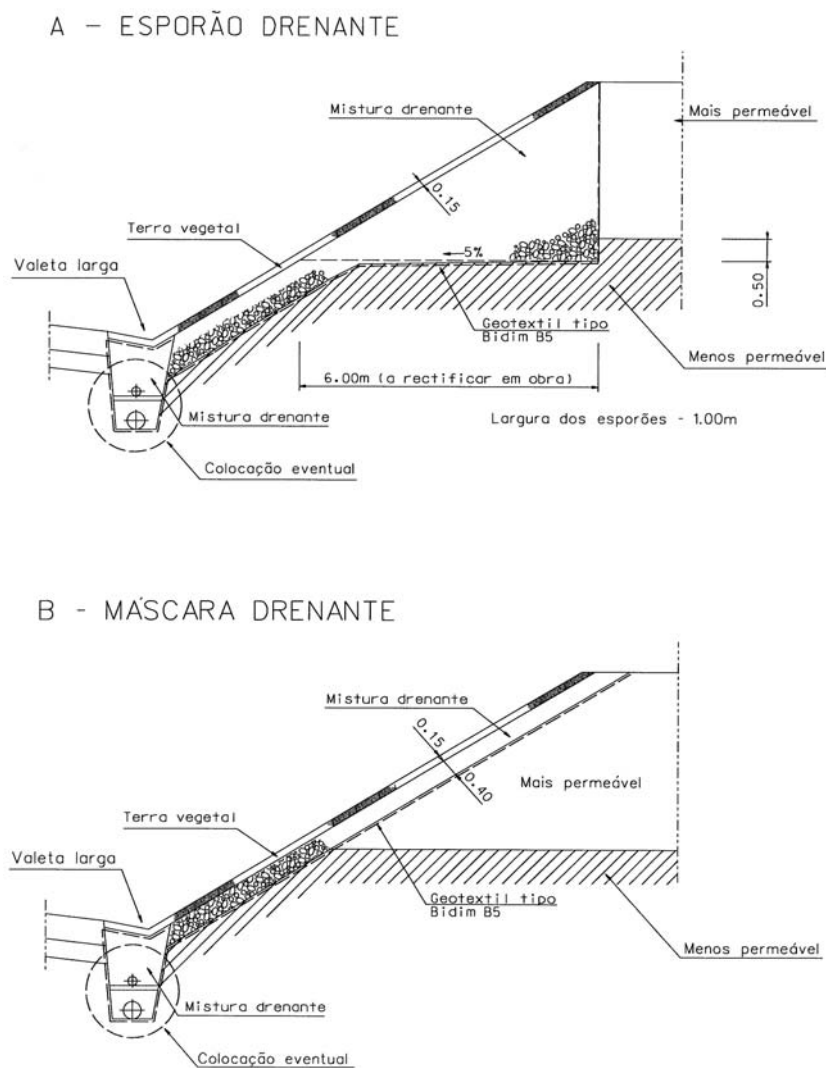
Esquema de Dispositivos de drenagem Subsuperficial do Tipo Máscara e Esporão Drenante
